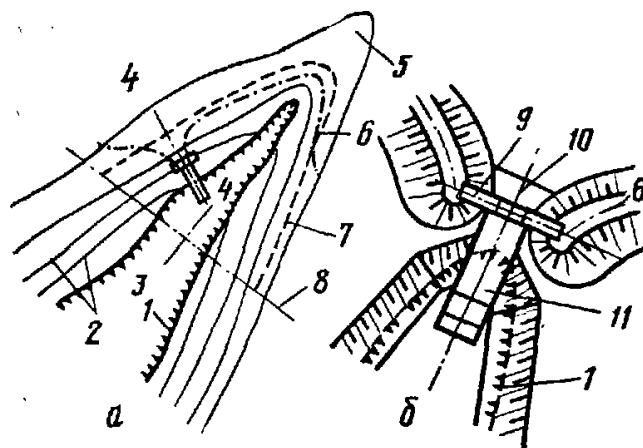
Варианты закрепления вершин оврагов:
